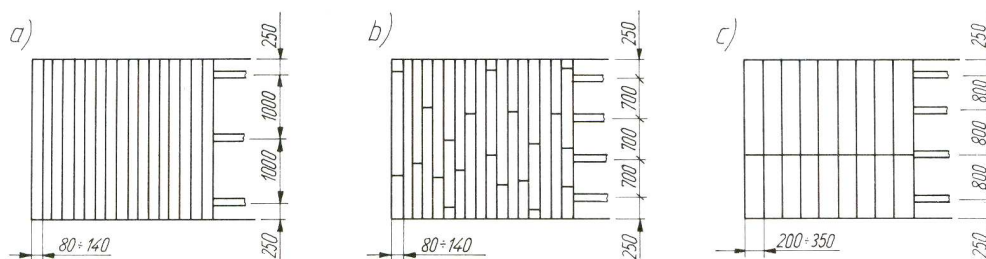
Konstrukcje boazerii: a) deskowa, b) ramowo-płytowa, c) płytowa [10, s. 255]
